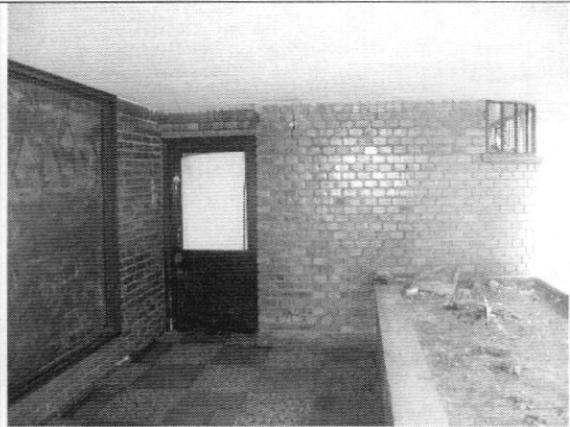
Muros en ladrillo a la vista en buenas condiciones
